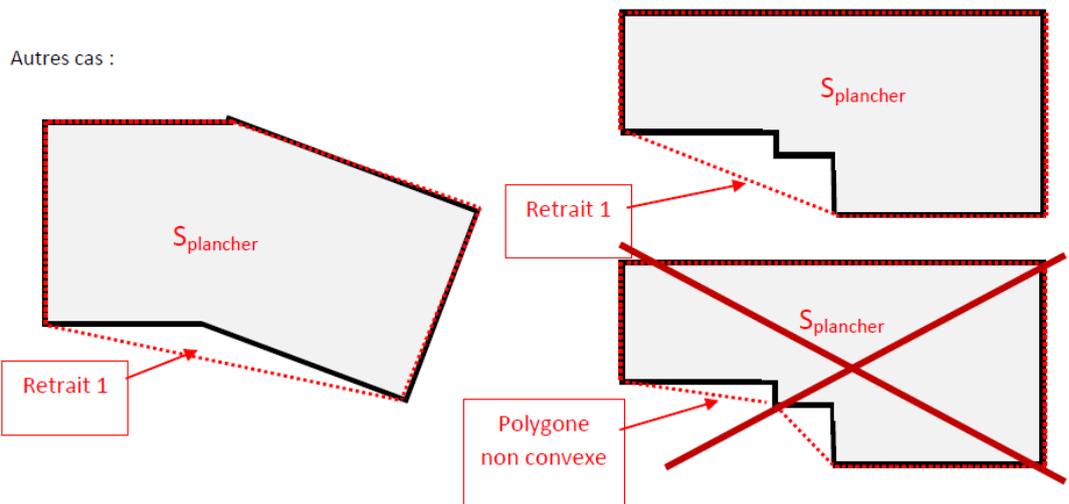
Critère b - Exemple d'application (autres cas)
